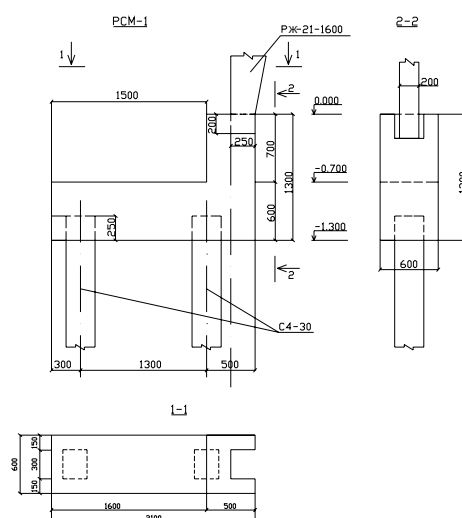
Конструкция свайного фундамента с монолитным ростверком с консолью в здании плавательного бассейна
